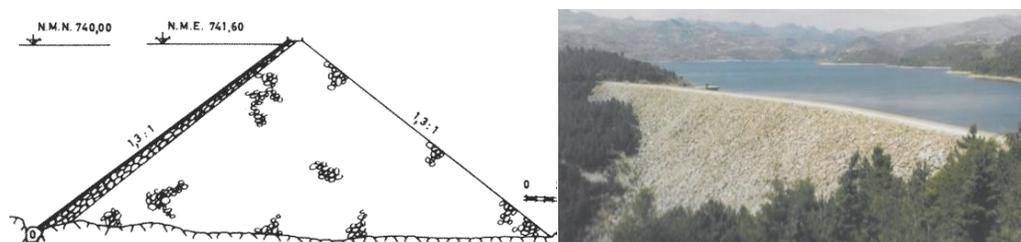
Perfil transversal e vista do paramento de jusante da barragem da Paradela.
